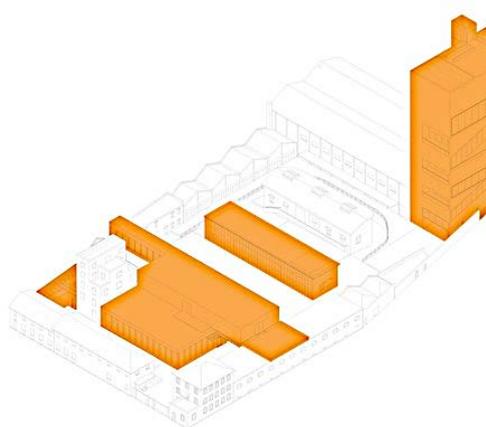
Esquema geral dos pavilhões da Fondazione Prada. Em laranja, as estruturas adicionadas.
